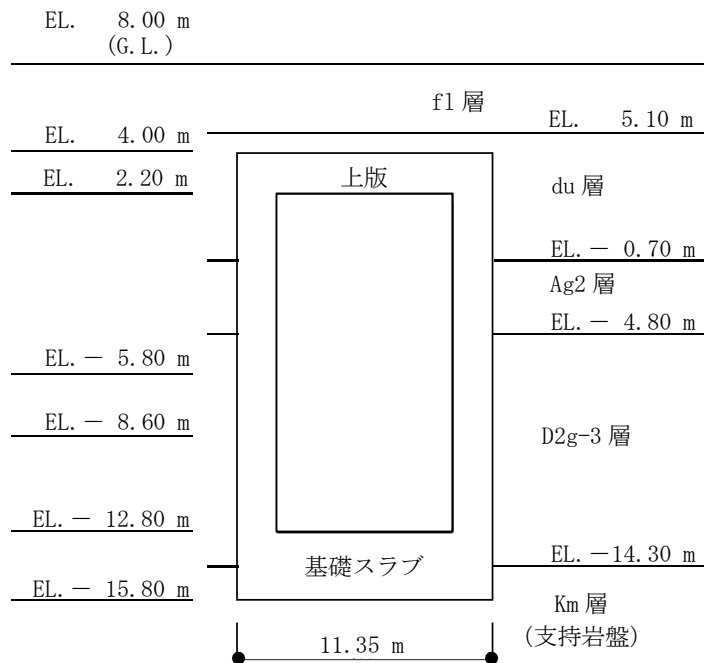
(2/2) 格納槽の概略断面図 (B-B 断面 EW 方向)
